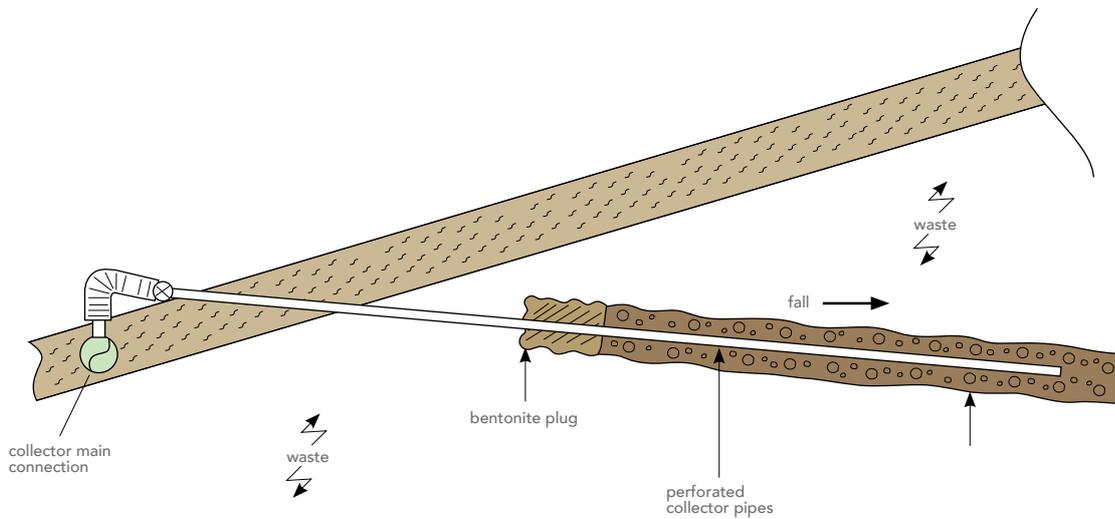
Instalasi kolektor horizontal pada parit, Thailand
